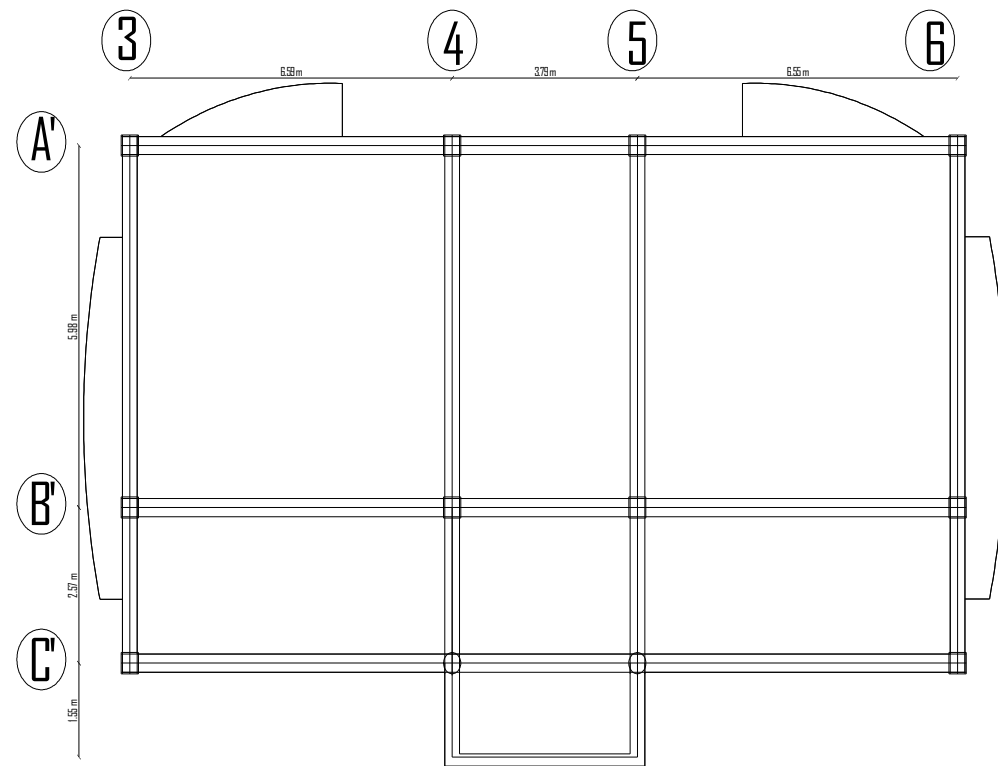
Secciones en planta de losetas, columnas, vigas, viguetas nivel N+7.58 bloque tres
